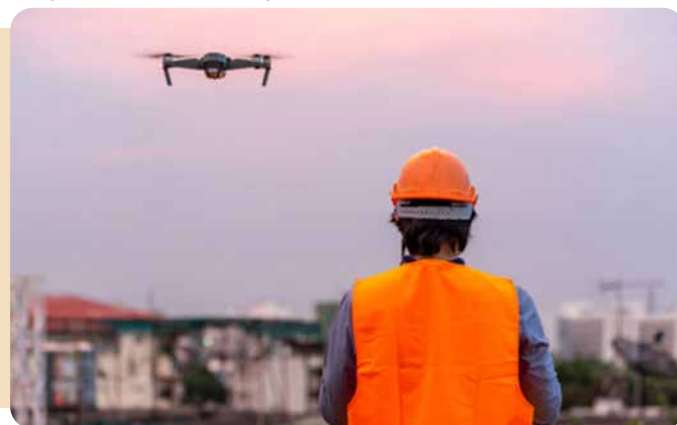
Captura de imagens de fissuras em estrutura via drone.
